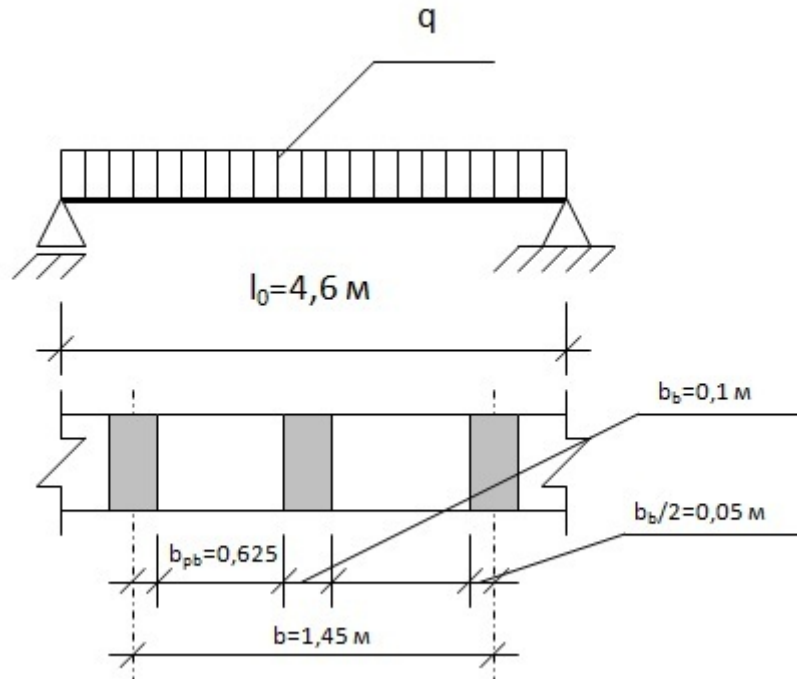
Расчетная схема перекрытия для расчета аналитическим способом
